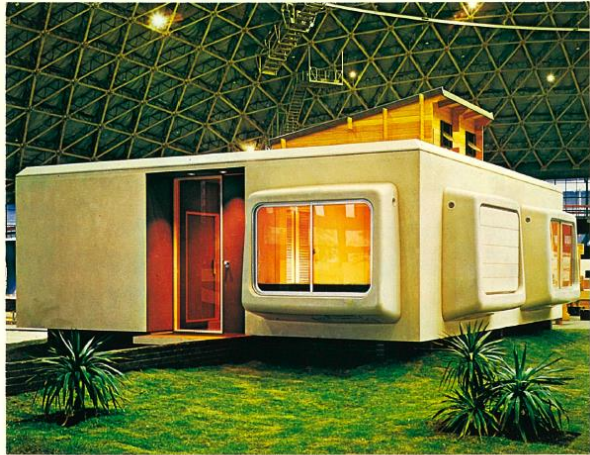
"MW-1"の全景写真 photo2: exterior of "Wall Units" MW-1
